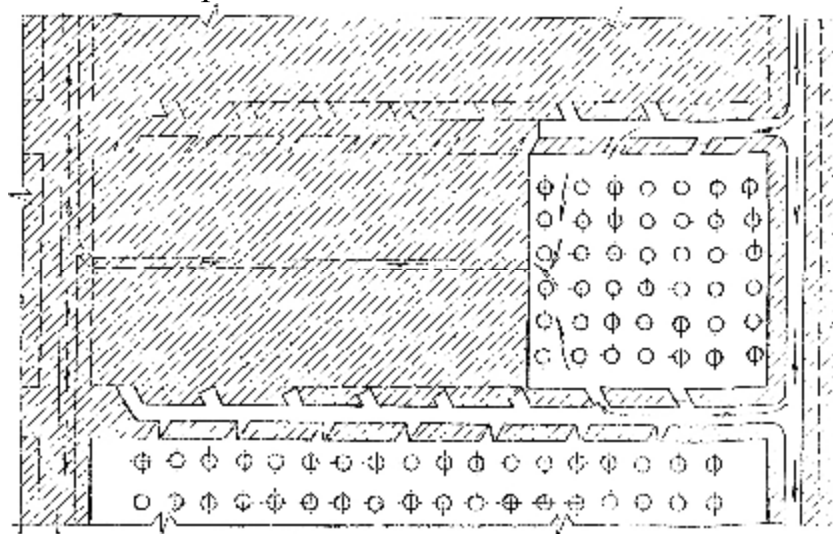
Схема вентиляции при сплошной системе разработки горизонтальных и слабонаклонных рудных тел.
